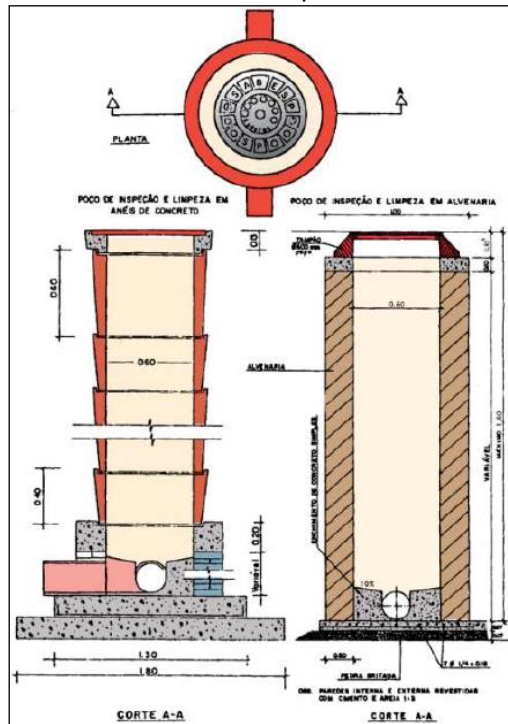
Poço de Visita em aduelas de concreto armado pré-moldado.
